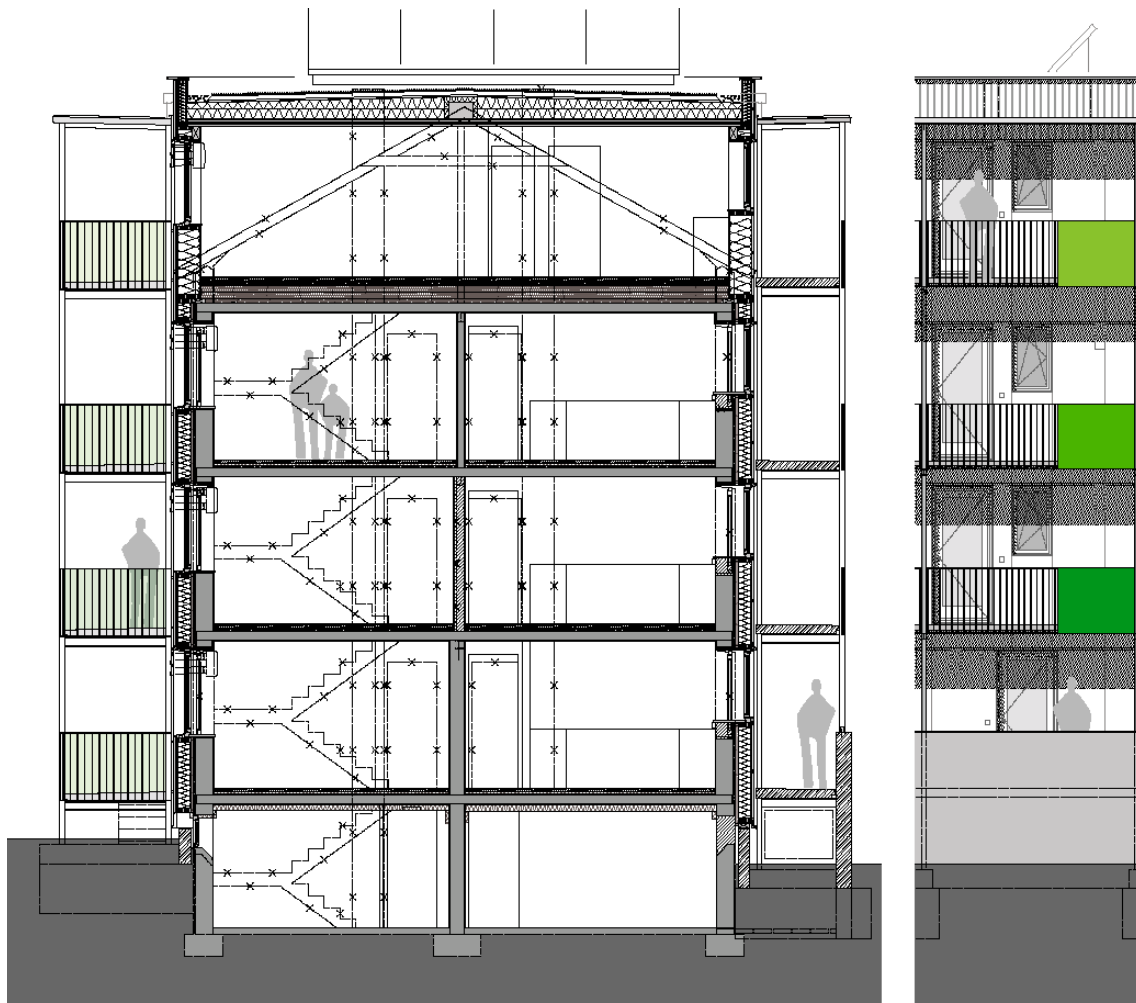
Erneuerung Nachkriegssiedlung München, Konstruktion Holz
